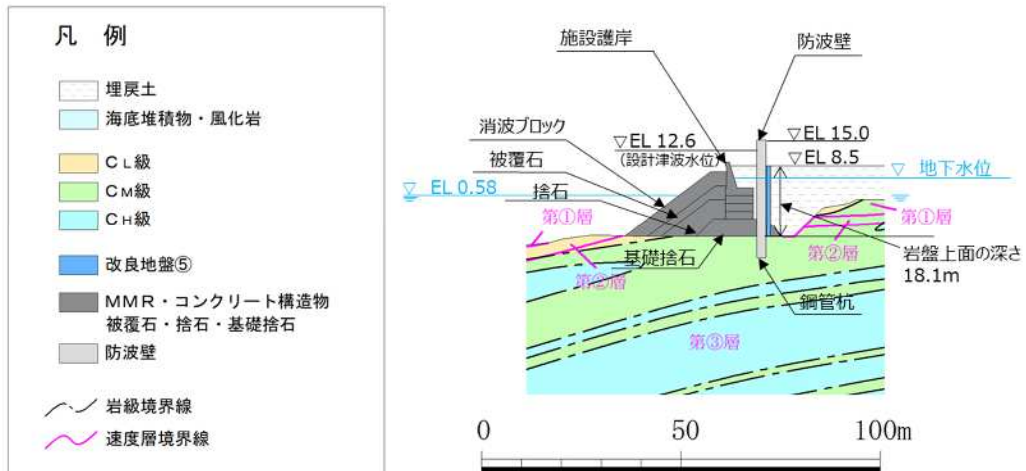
防波壁（多重鋼管杭式擁壁）の横断面図一般部（①-①断面）
